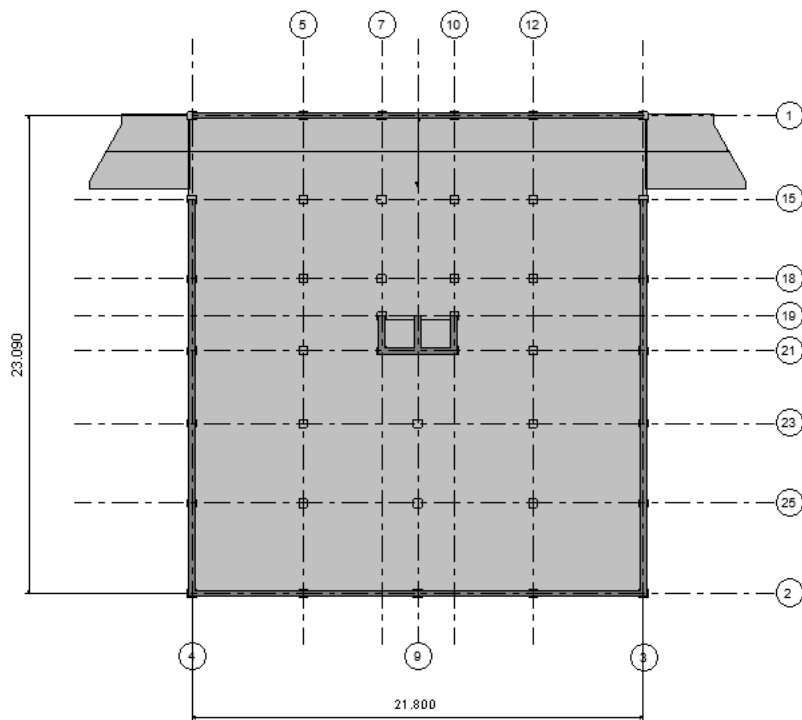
Planta estrutural da cave da solução estrutural 2 (Revit).
